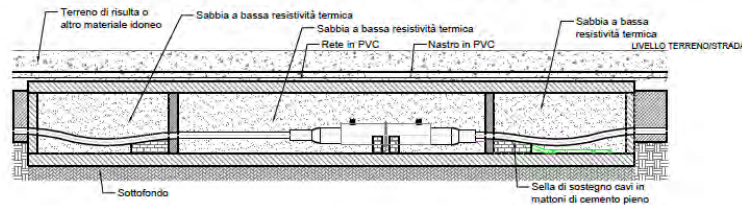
Pianta e sezione tipo della buca giunti prefabbricata. Tavola tipologico buche giunti.
